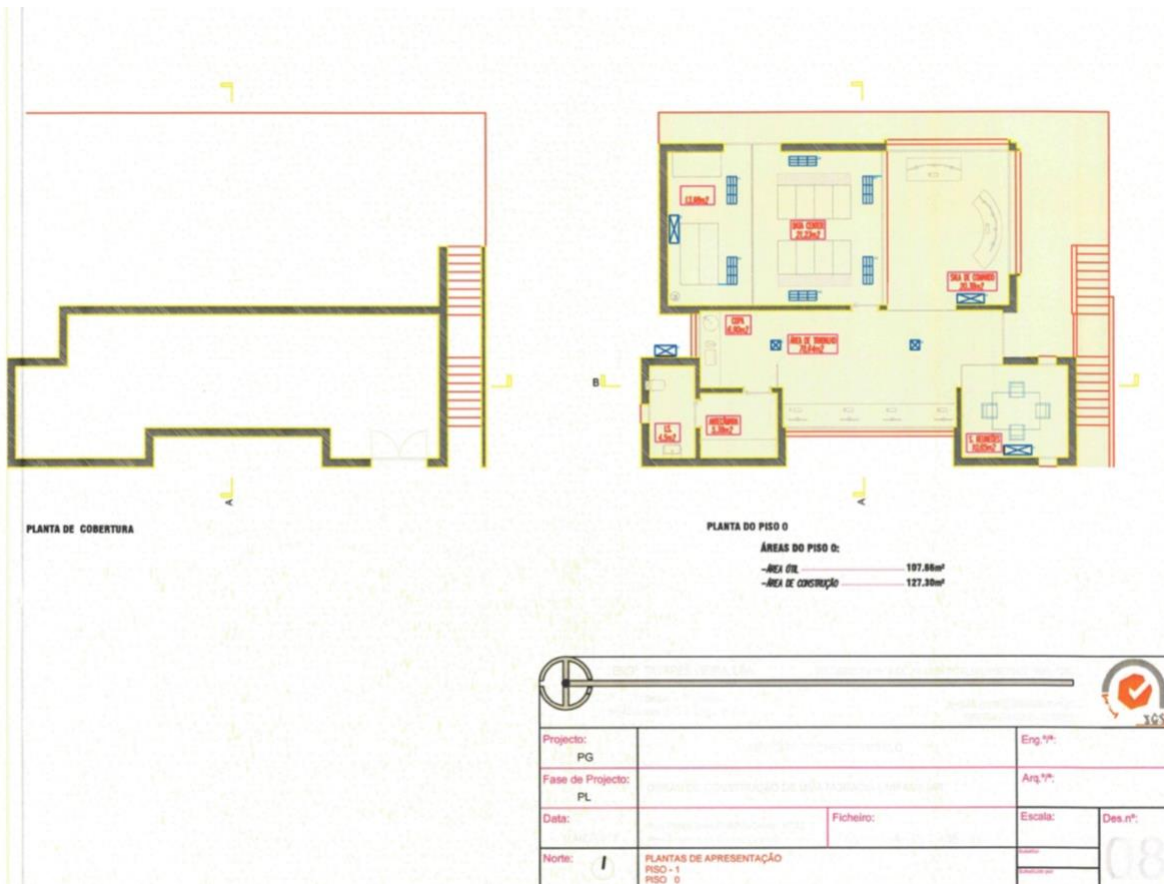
Planta de cobertura e planta do piso 0 do edifício central de comandos
